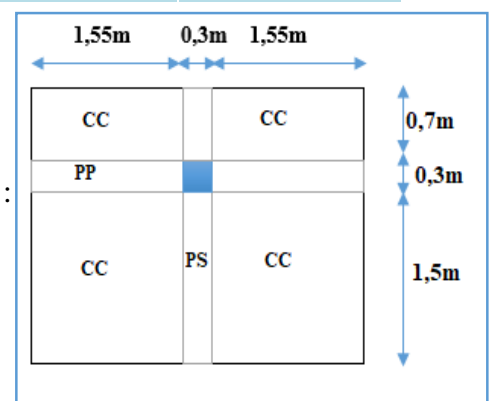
La surface reprise par le poteau de rive « Niveau terrasse ».
